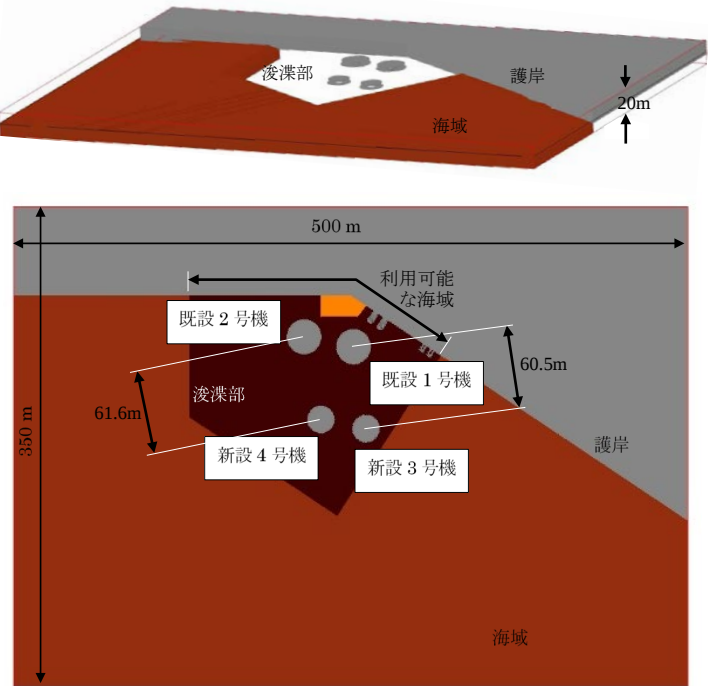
解析モデルの鳥瞰図及び平面図 (案1の場合)
